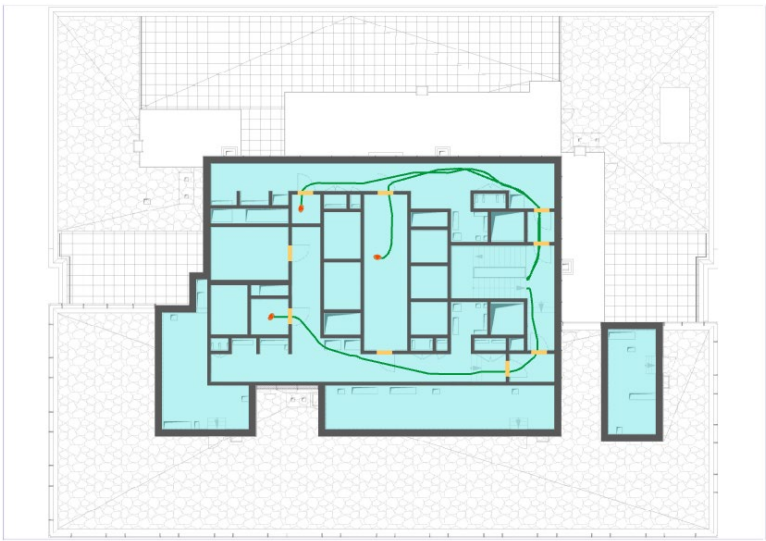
План техэтажа на отм. +116.250 и нанесенная на него расчетная (принципиальная) схема эвакуации
